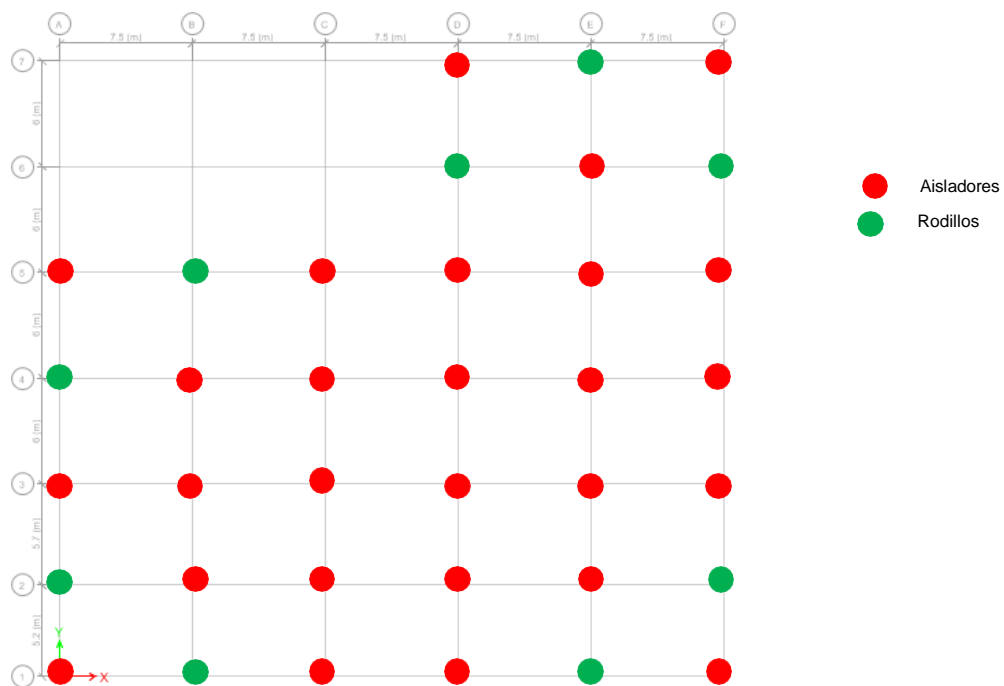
Vista en Planta de los aisladores y deslizantes de la Estructura B
